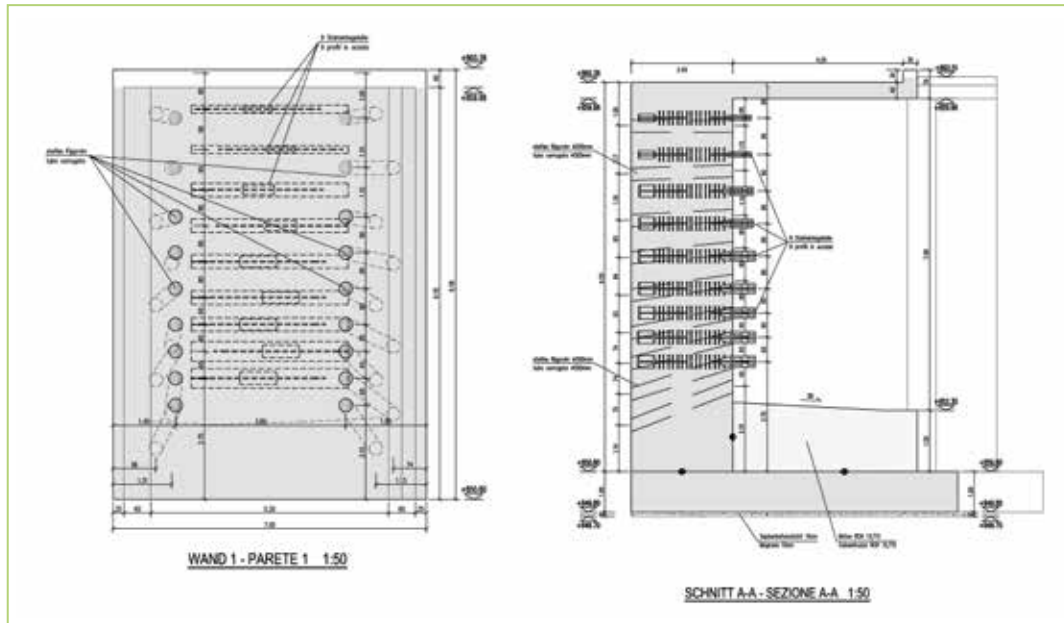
Ankerbetonblock in Vorderansicht und seitlichem Schnitt
